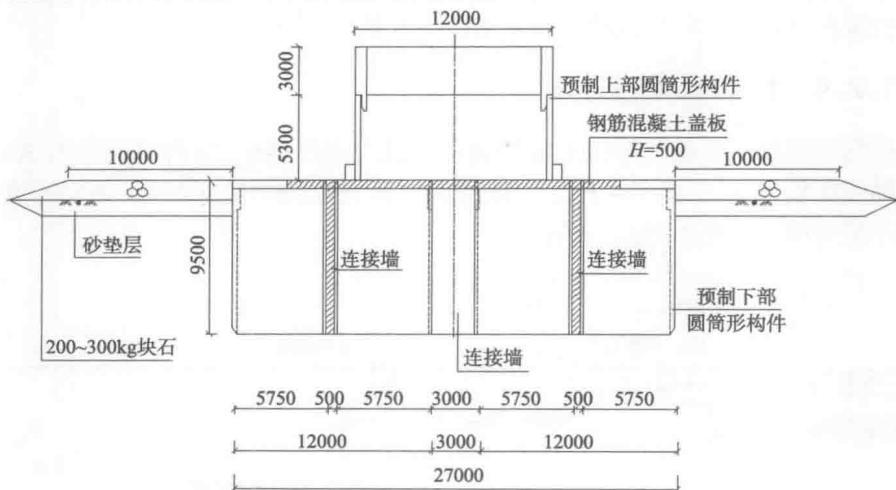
箱筒形基础防波堤结构断面图(尺寸单位:mm)
